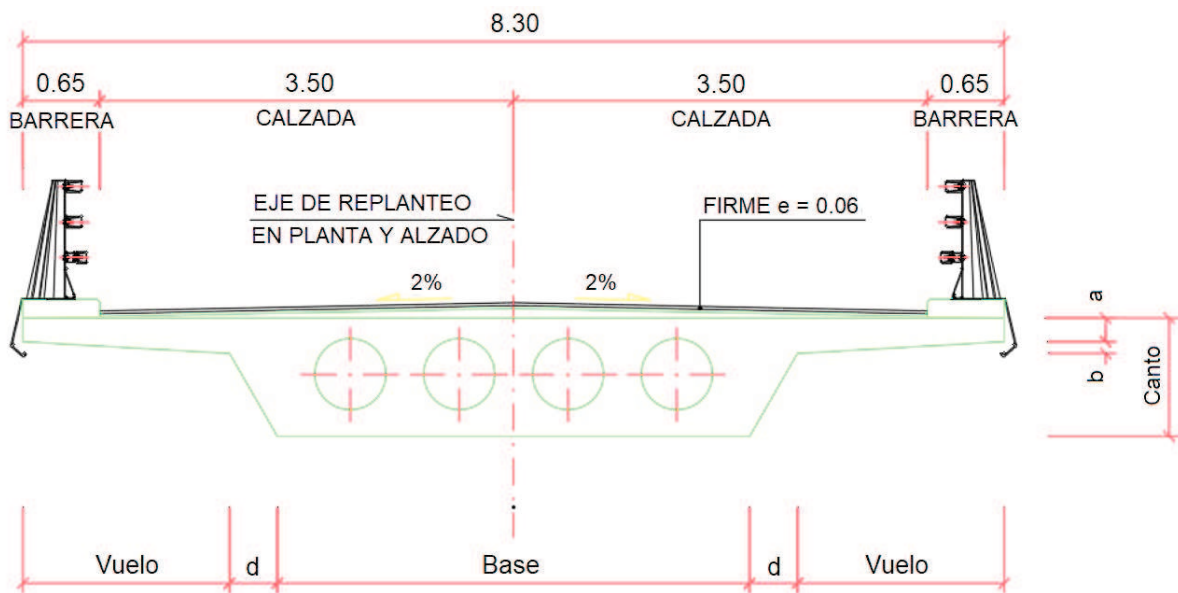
Sección transversal tipo del tablero de puente losa pretensado aligerado.
